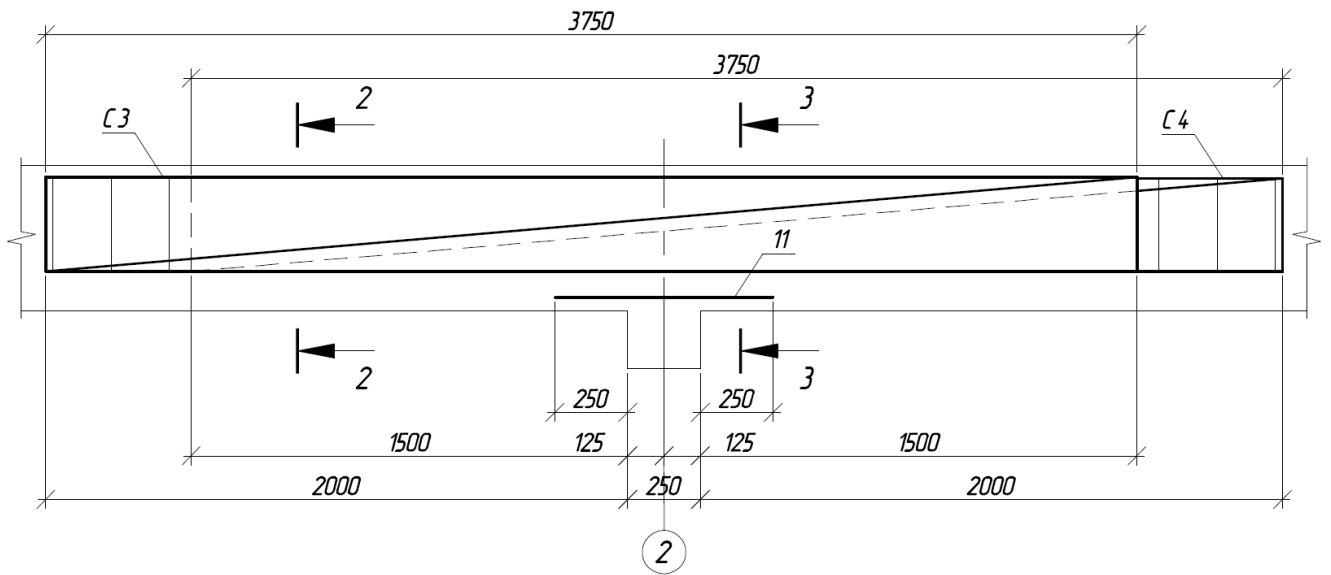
Схема армирования второй опоры второстепенной балки
